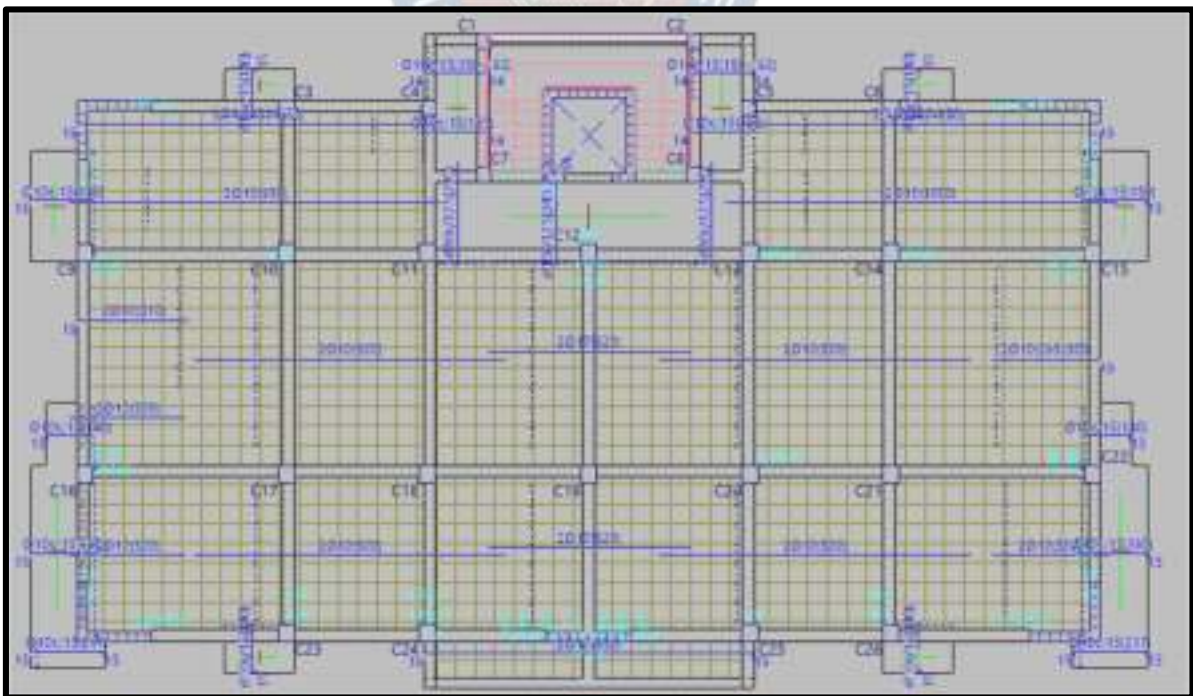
Esquema de armado longitudinal superior en dirección “X” s/ CBH – 87
